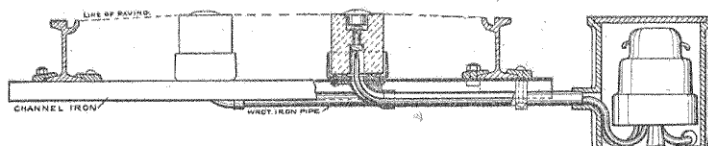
Coupe d'une voie de tramways. (Dernière disposition).
